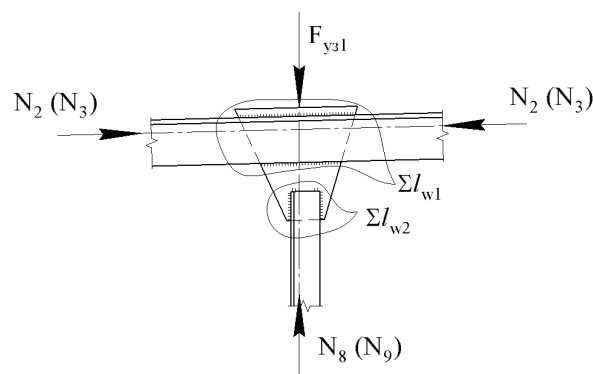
Узел примыкания к верхнему поясу нагруженной стойки.
